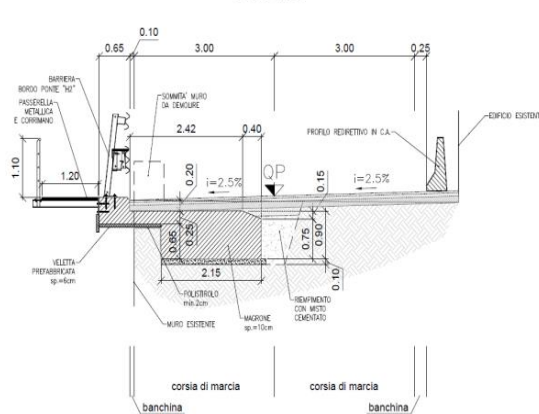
a e b Sezione tipo "Tratta 3"
